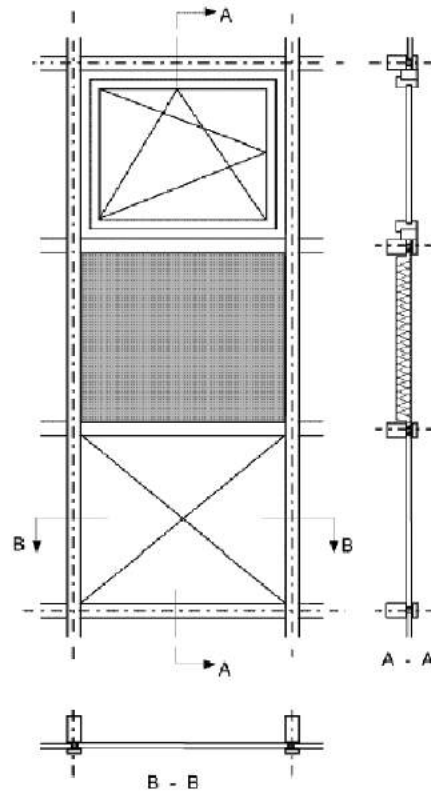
Element einer Vorhangfassade (vorgehängte Wand)
